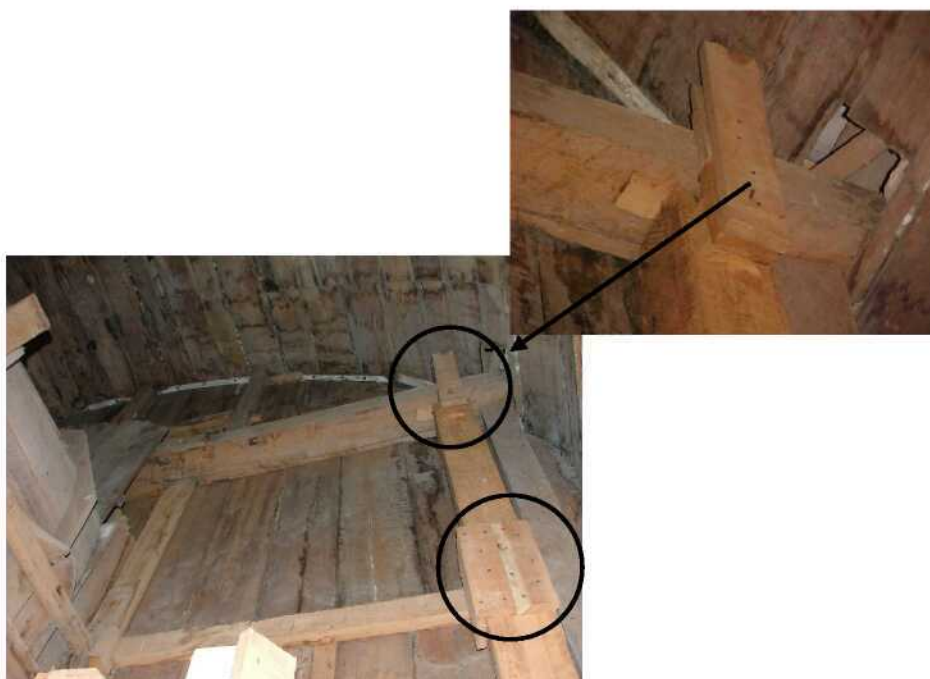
Substituição de esteio utilizando sambladura em prolongamento com tala. Detalhe do reforço com sambladura de borda. Fotos da autora. 2005.
